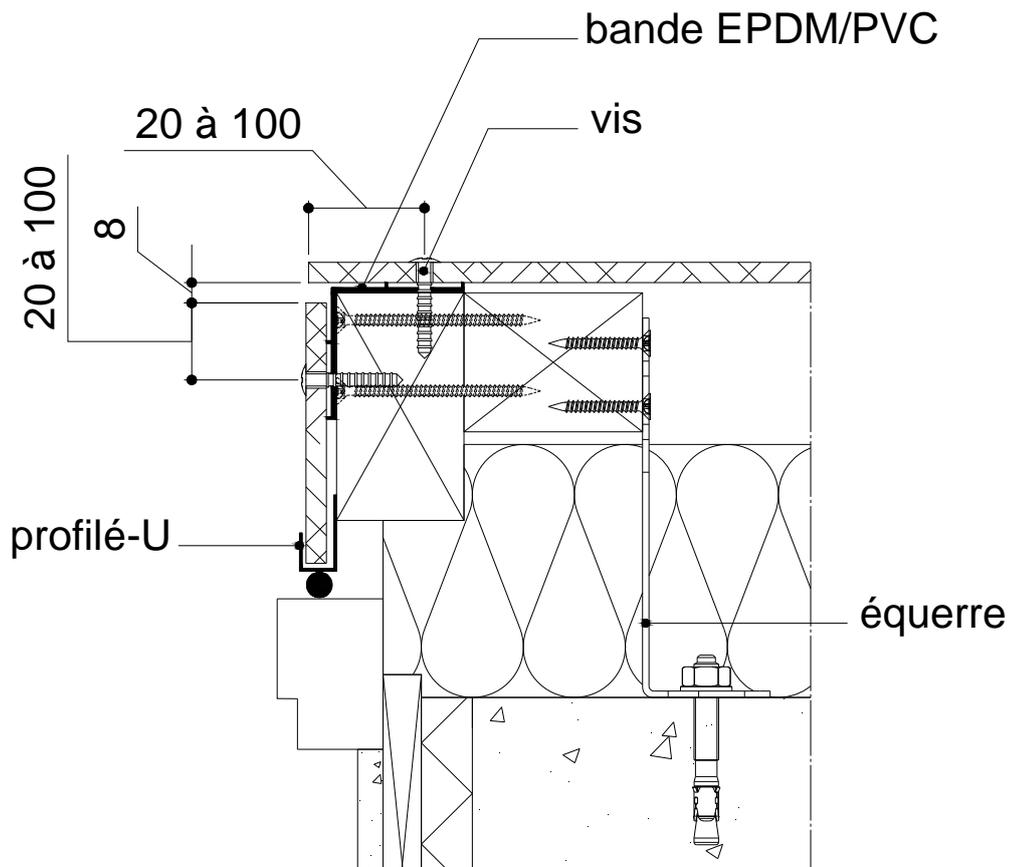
Détail tableau sur ossature bois (cote en mm)
